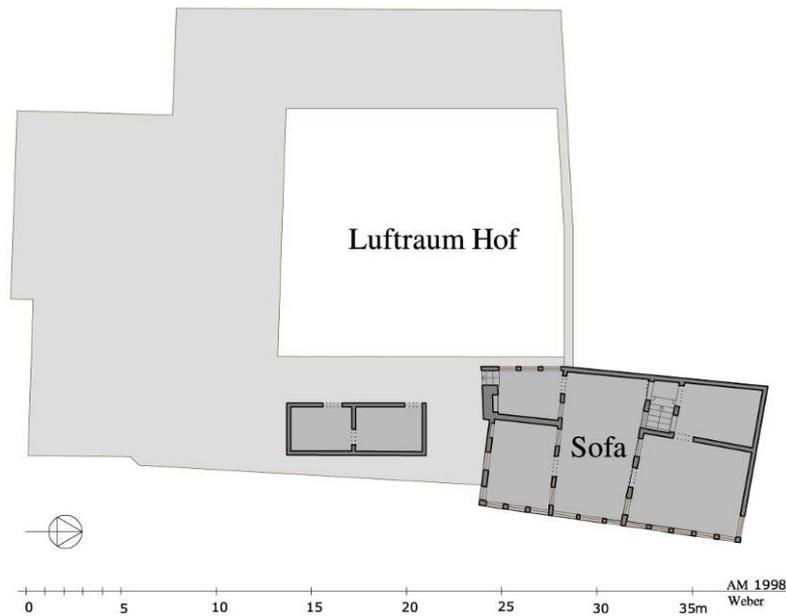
Bayt al-Mallūk, Grundriss OG
